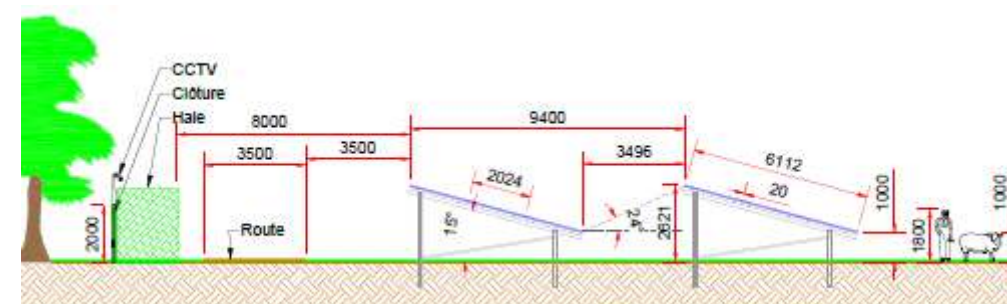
Plan de coupe des structures photovoltaïques avec la piste d'accès
